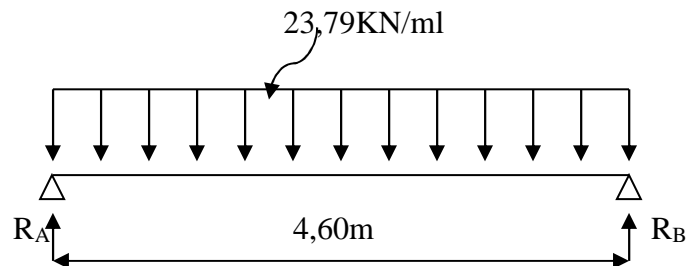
Schéma statique de la poutre palière l'ELS.
